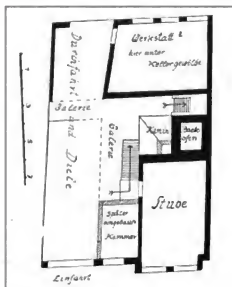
Grundriss eines Renaissancehauses, Northeim, Breite Str. 37
